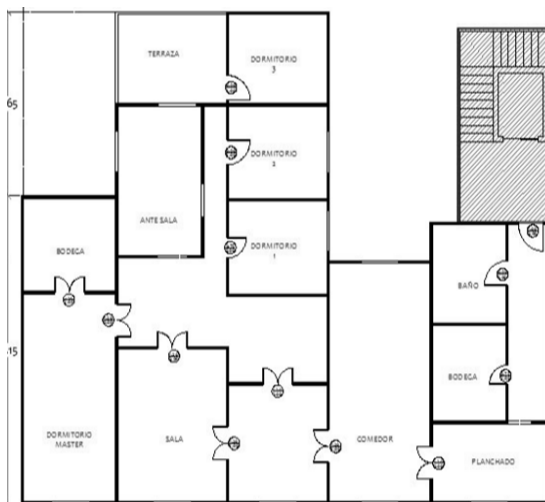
Plano arquitectónico de la planta alta de la Casa Aguilar. (INPC, 2017)
